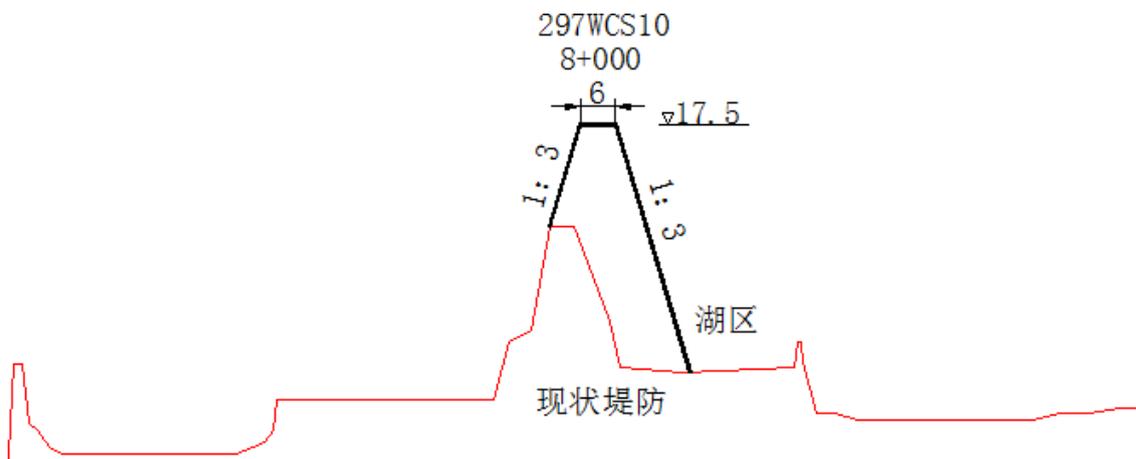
三河农场一区迎湖挡洪堤加固设计代表断面图
